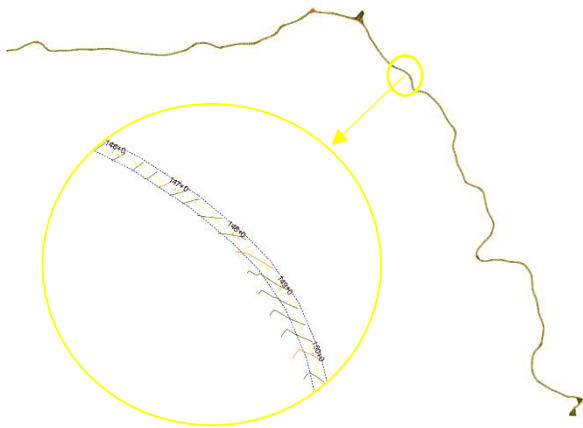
Planta Baixa Topográfica do trecho 1 – Montanhosa. Fonte: o Autor 2022.
